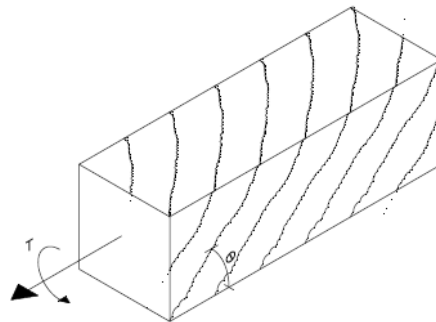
2 Viga de hormigón armado agrietada por esfuerzos de torsión.
